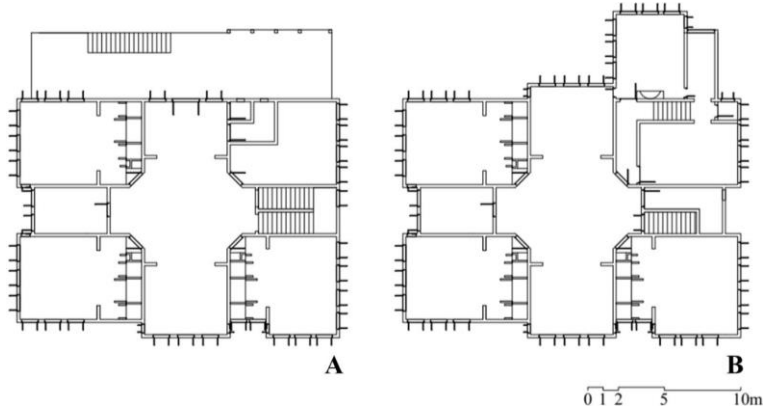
Hollanda Büyükelçilik Konutu, kat planları. A) Alt kat planı B) Üst kat planı
